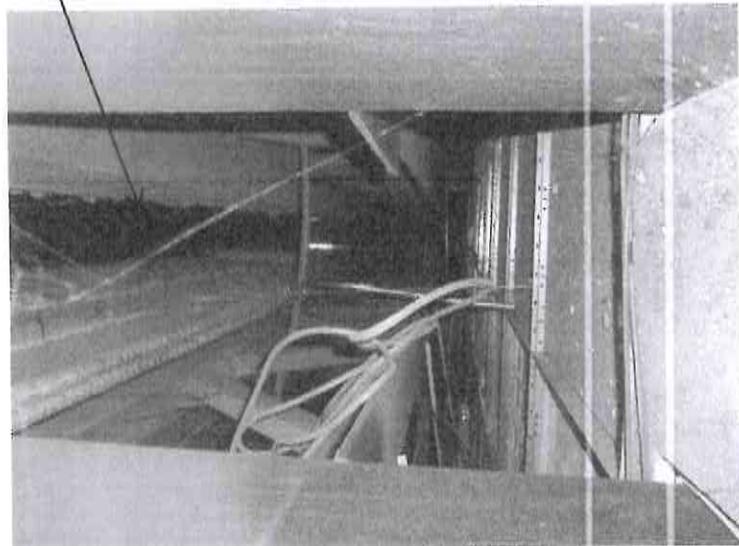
y 46.- Vista de las columnas D13, ubicadas sobre el eje 13, donde solo se advierten grietas en el cajillo de tablaroca y no se aprecia la separación como en el caso de las columnas ubicadas en la intersección de los ejes B-13.
